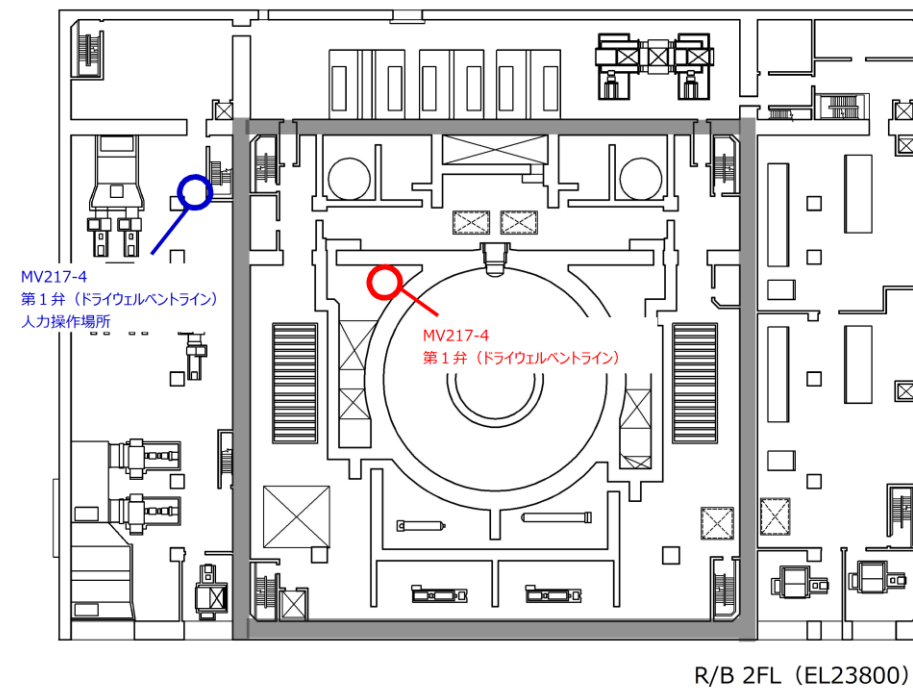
格納容器フィルタベント系 弁の設置位置 (その3)
